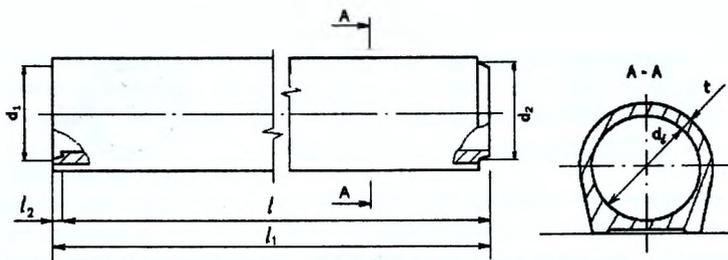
Общий вид труб типа ТФП (БТФП) – железобетонных (бетонных) цилиндрических фальцевых с подошвой
